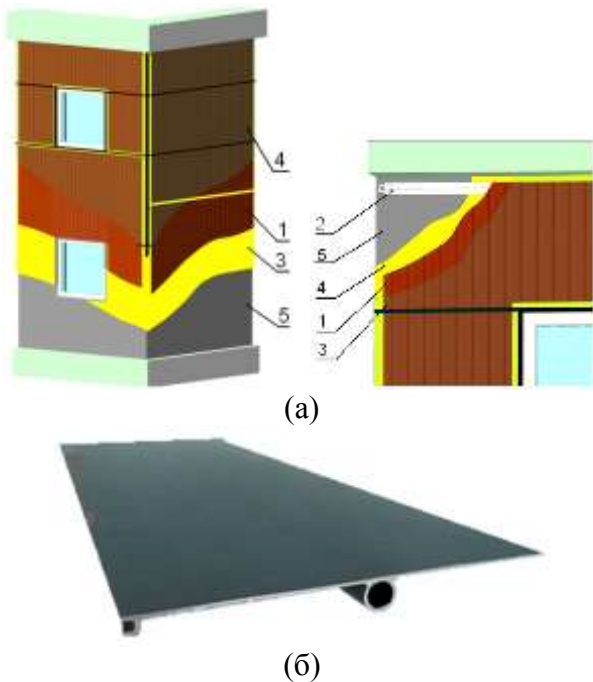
Фасад здания на основе АТТ при его реновации: а – конструкция; б – профиль АТТ; 1 – АТТ; 2 – теплообменник; 3 – стекло; 4 – изоляция; 5 – стена здания.
